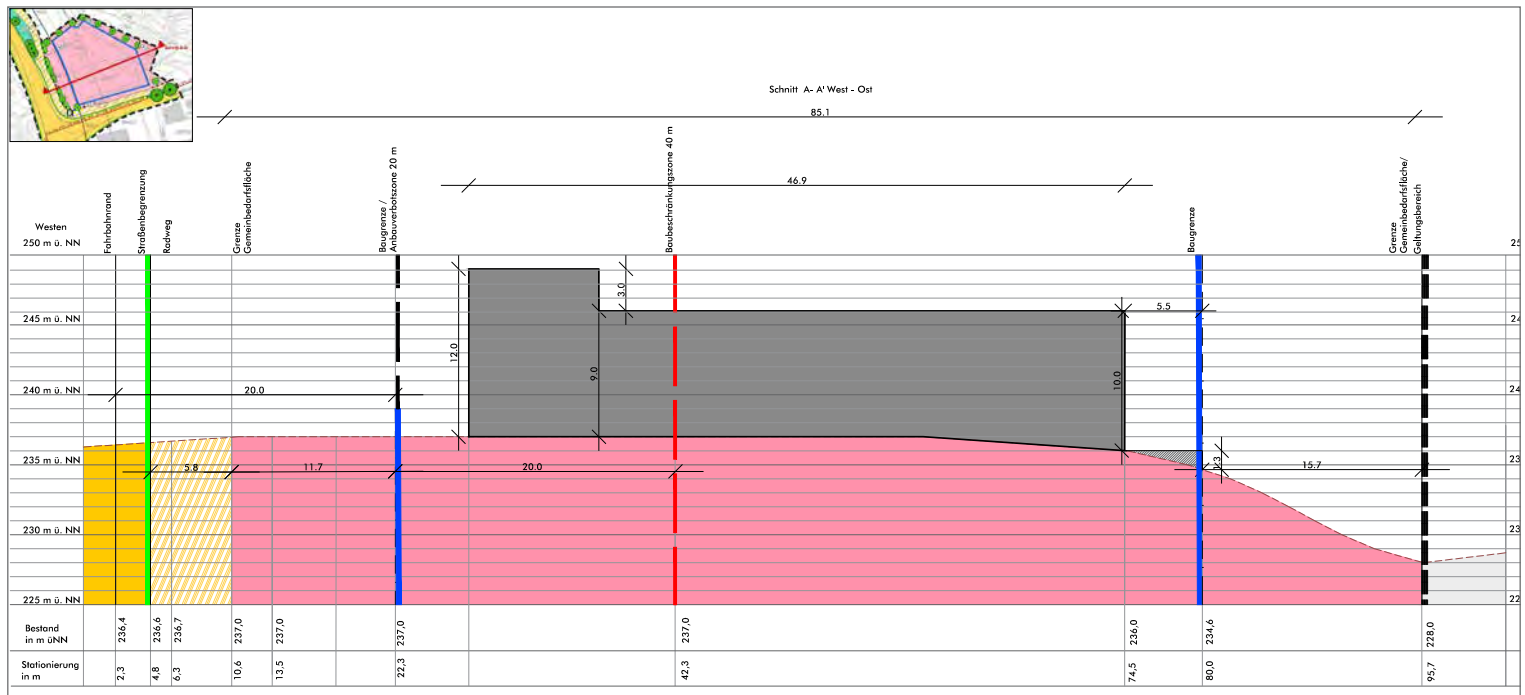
schematischer Schnitt der geplanten Bebauung
